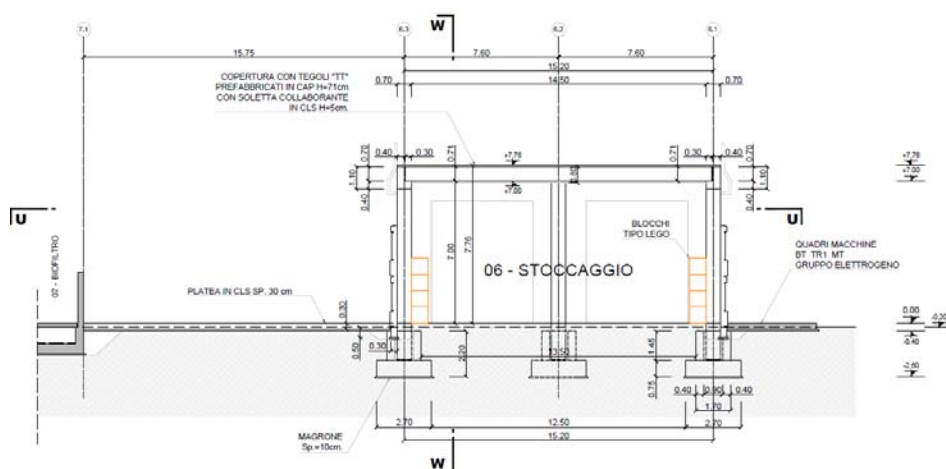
SEZIONE TRASVERSALE STOCCAGGIO
